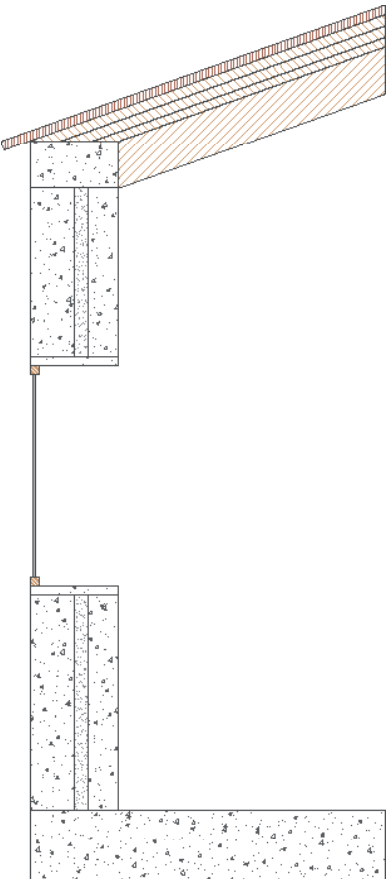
Detalle constructivo edificio existente. HTFLUX
